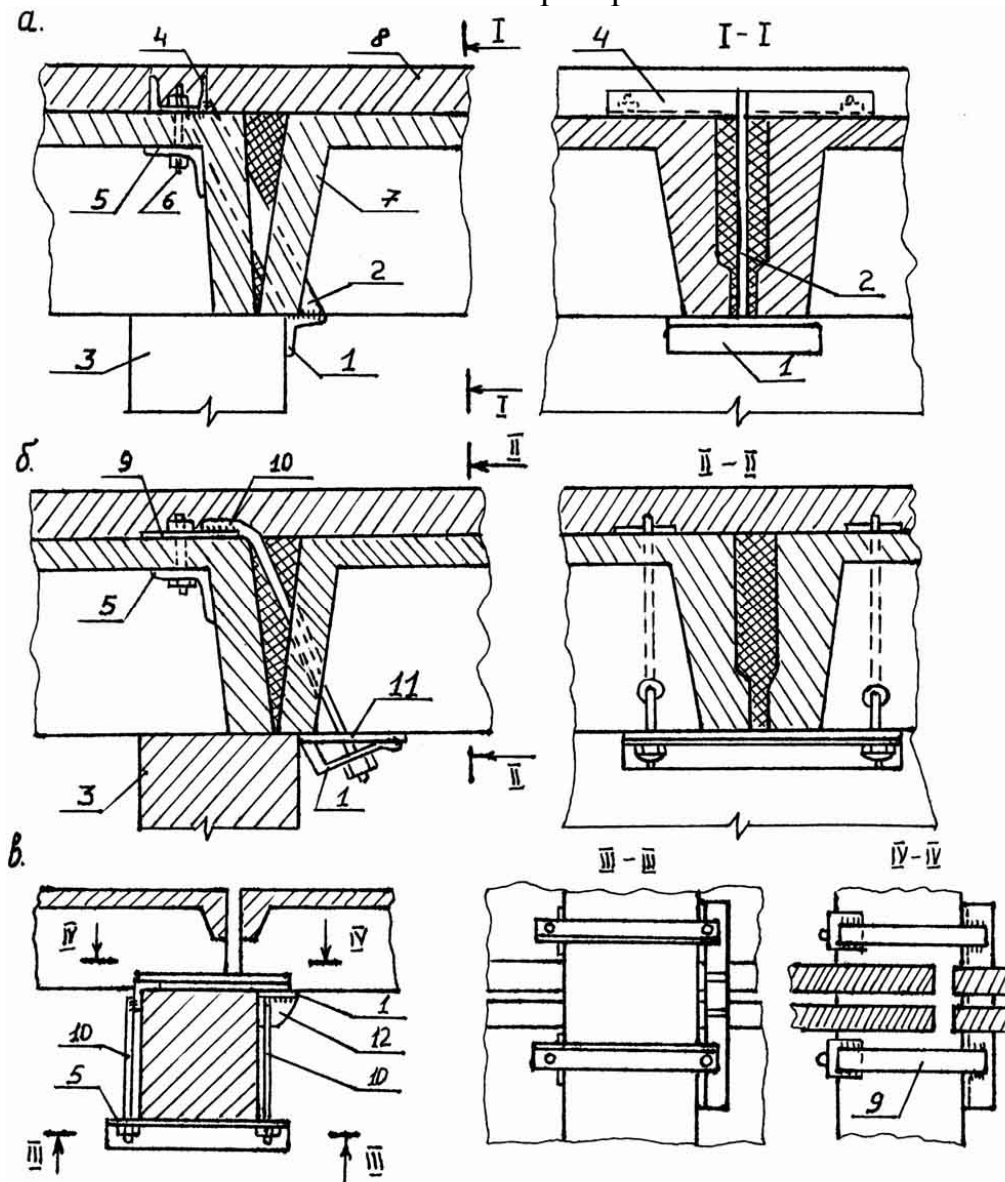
Усиление зоны стыка плит перекрытия с ригелем:
